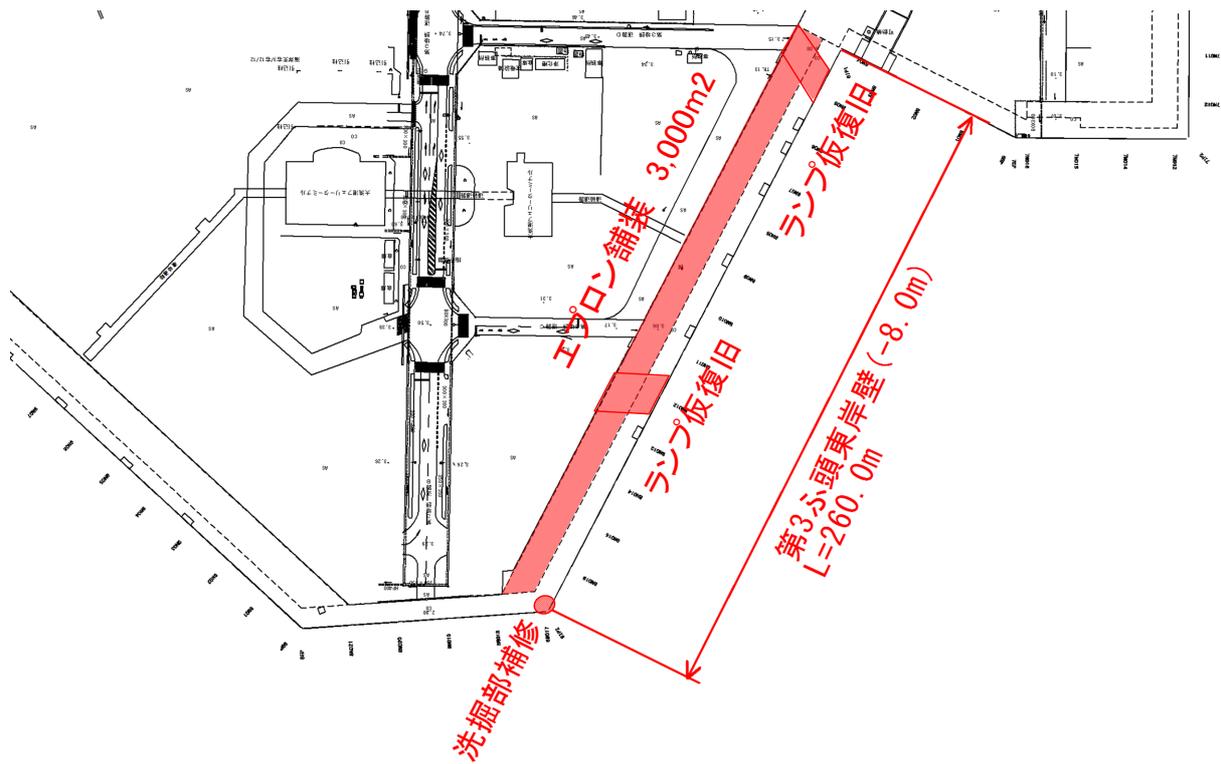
No.33 大洗港区_第3埠頭地区東岸壁 (-8m) の平面図 (被災前)
